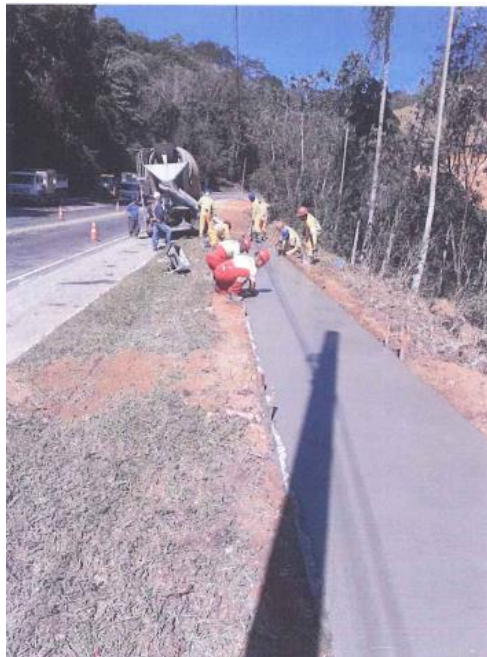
Rota 116 – Reparos de pavimento – km 85 ao 87
